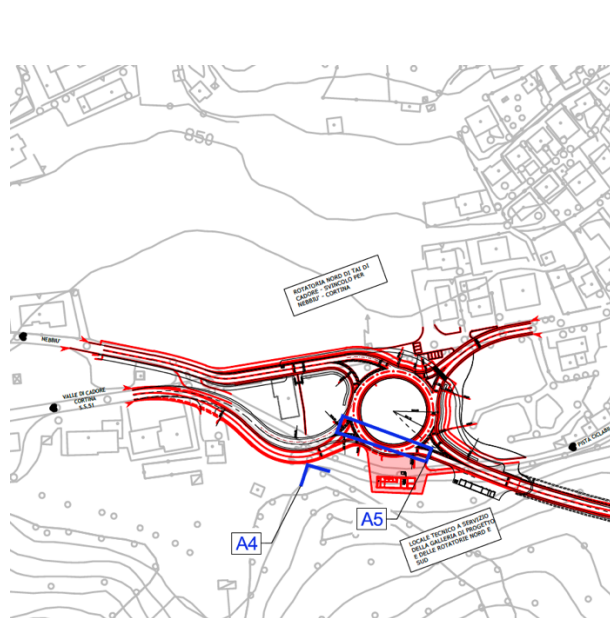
Confronto tracciati su planimetria archeologica: dettaglio Svincolo Tai Ovest
